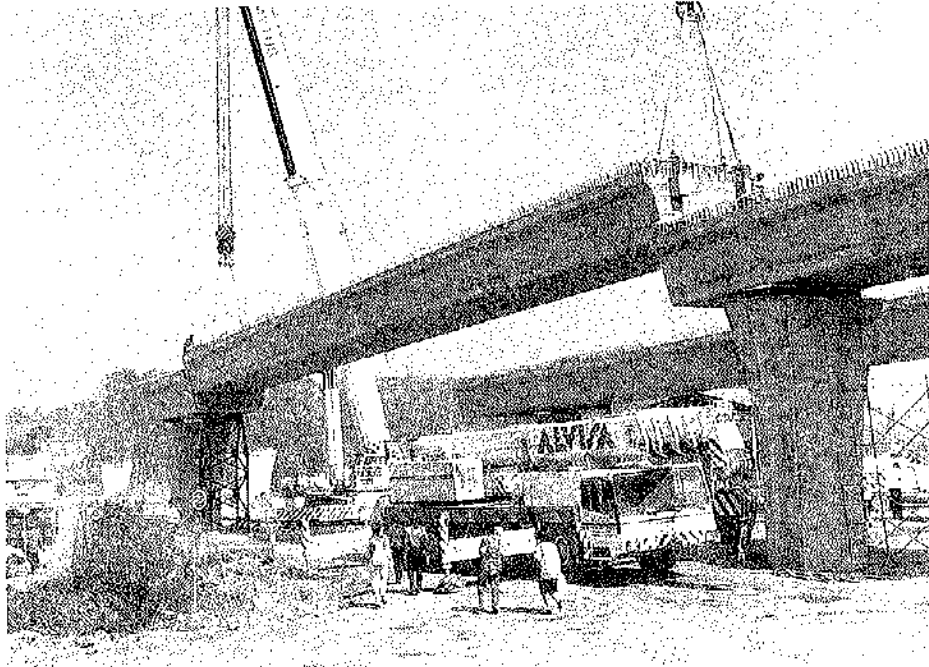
Vigas artesa para tableros monocelulares continuos, de canto constante. Luz entre ejes de pilas  $\leq 43$  m.
